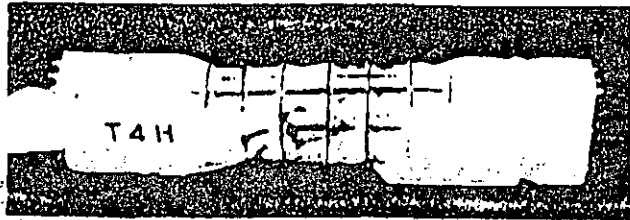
Viga de yeso reforzada en la falla de torsión pura
